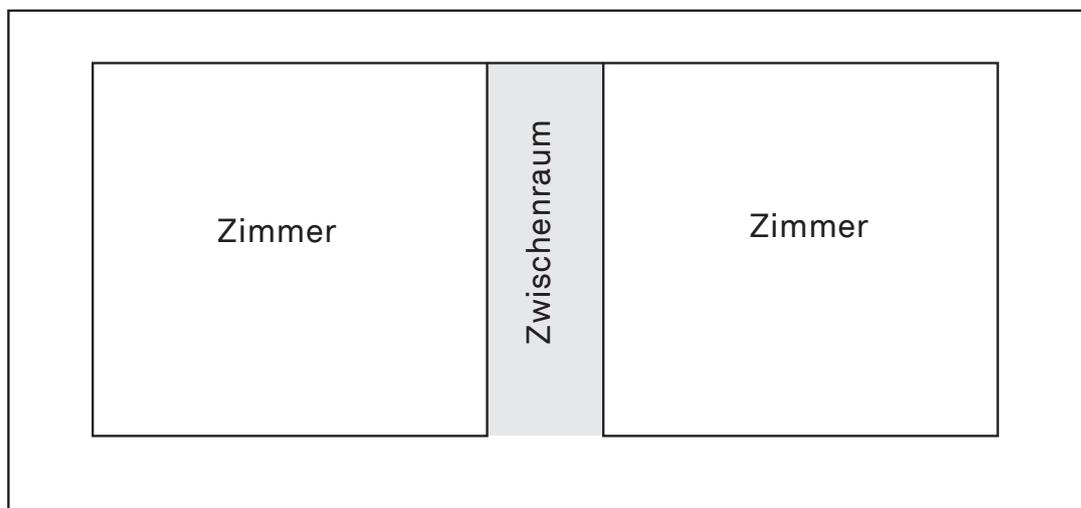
Grundriss eines typischen Shelters
